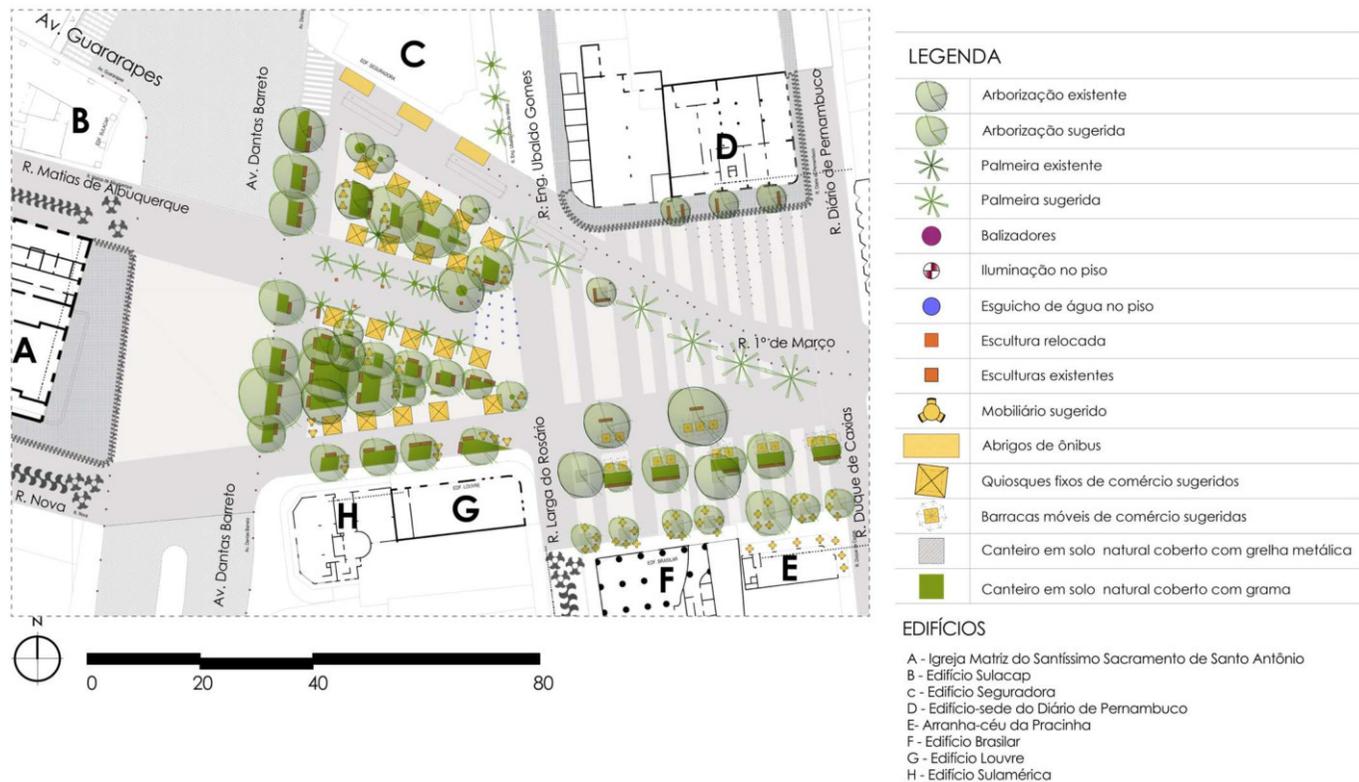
Planta Baixa das Diretrizes com proposição do traçado e pisos. Fonte: De autoria própria, 2022.
